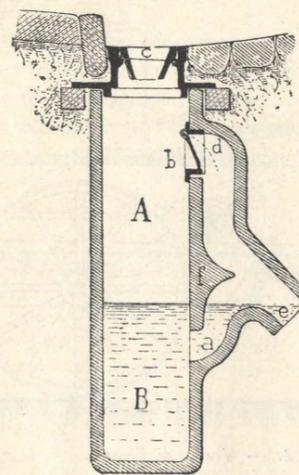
Pozzetto a sabbia tipo tedesco (Sezione verticale).
